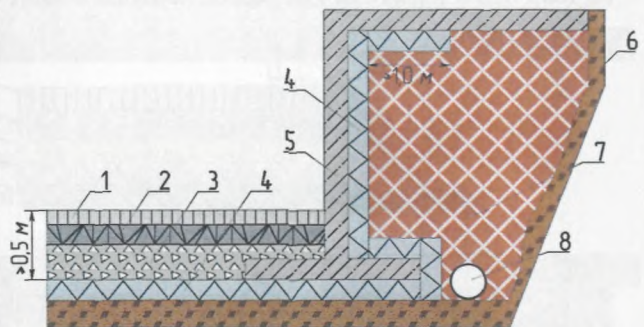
Подпорная стенка с боковой теплоизоляцией
